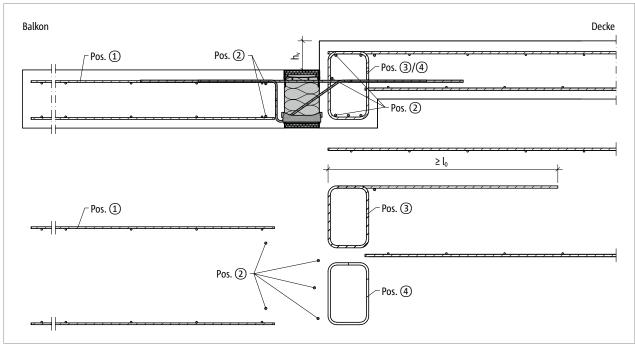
Schöck Isokorb® XT Typ K: Bauseitige Bewehrung für kleinen Höhenversatz
